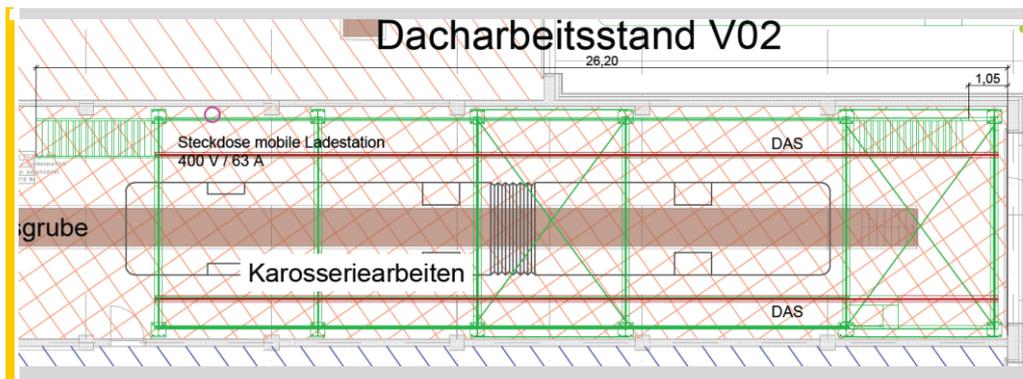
Grundriss DAS Variante 2
